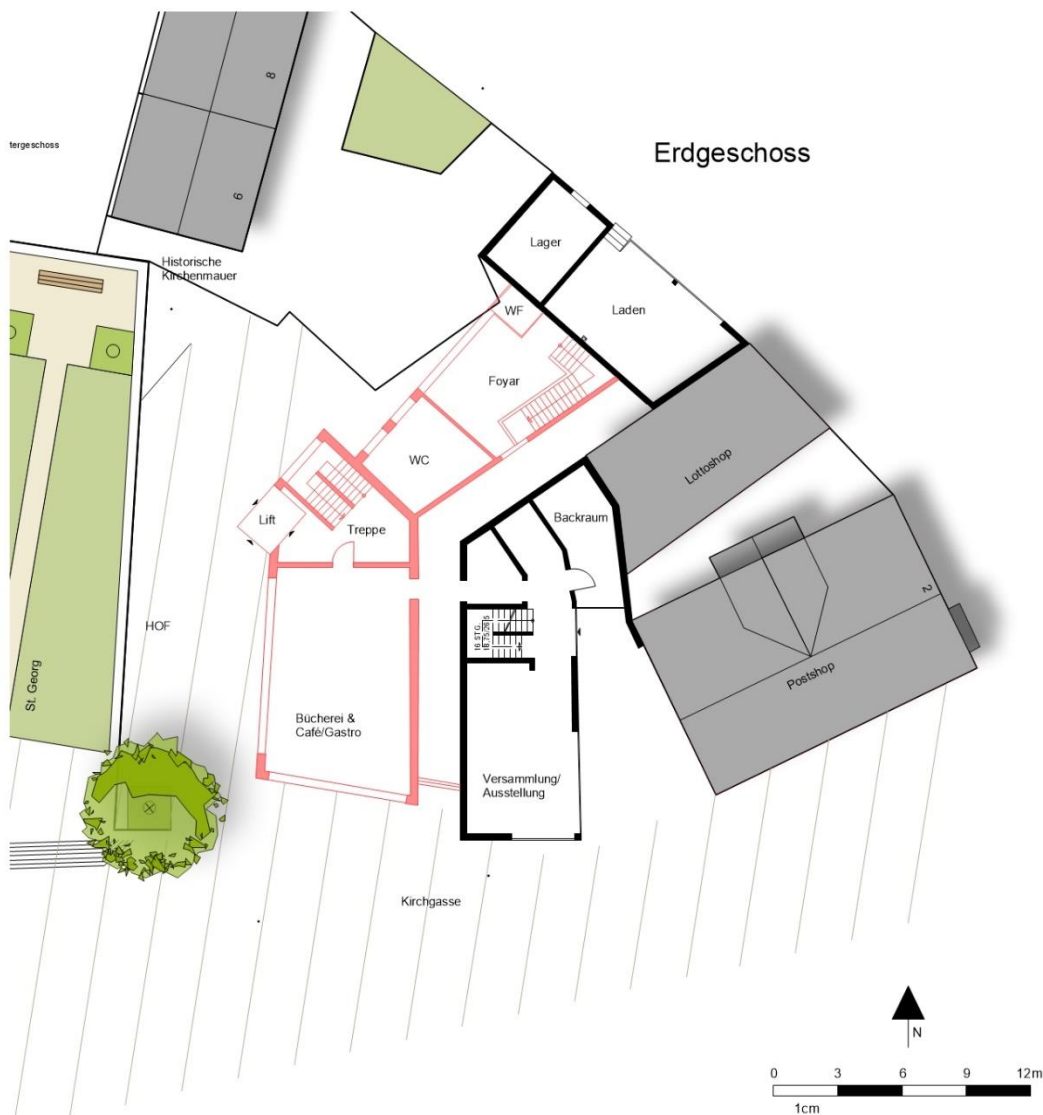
Grundriss der Gebäude der Kirchgasse 1 und 3 sowie Bornhohl 4
